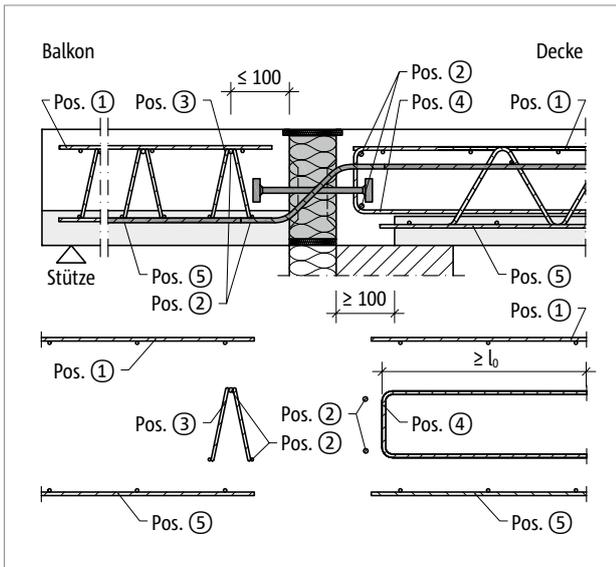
Schöck Isokorb® T Typ Q-P: Bauseitige Bewehrung mit Gitterträger
